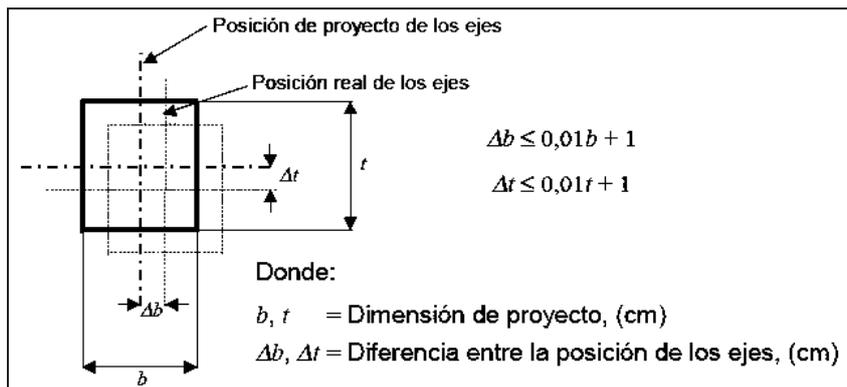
Tolerancia para posición de columnas [16].
